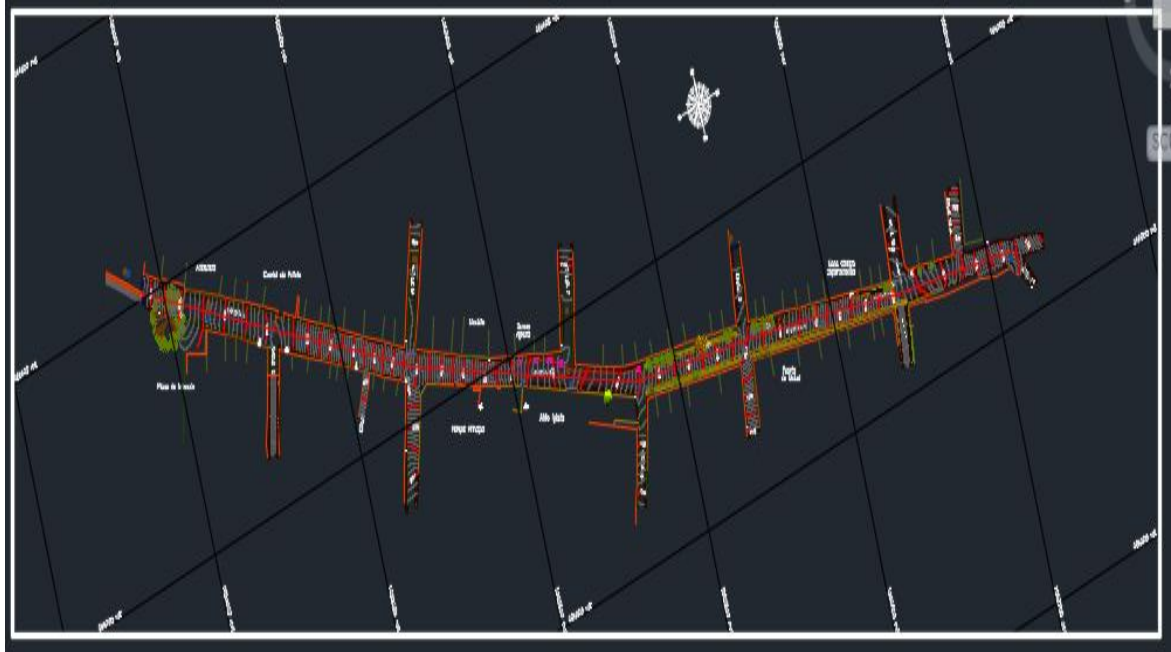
Plano No. 2. Plano geométrico del levantamiento
